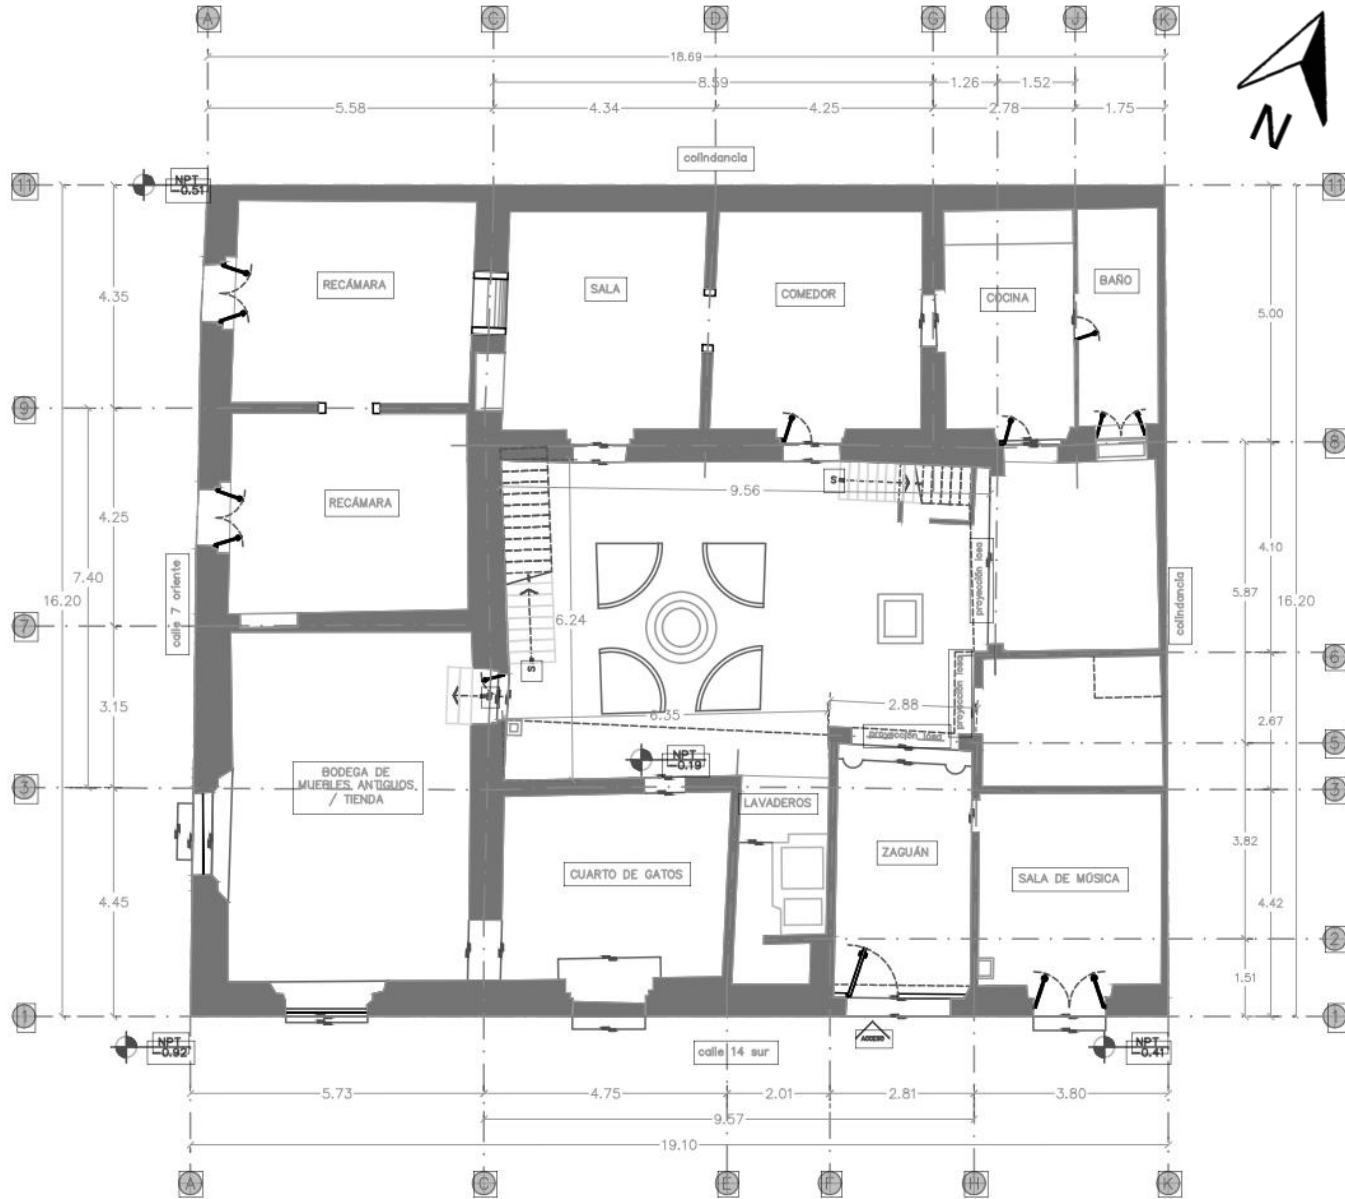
Plano de levantamiento de Planta Alta "Casa Anarco" Fuente: Elaborado por el equipo de Re Genera Espacio
